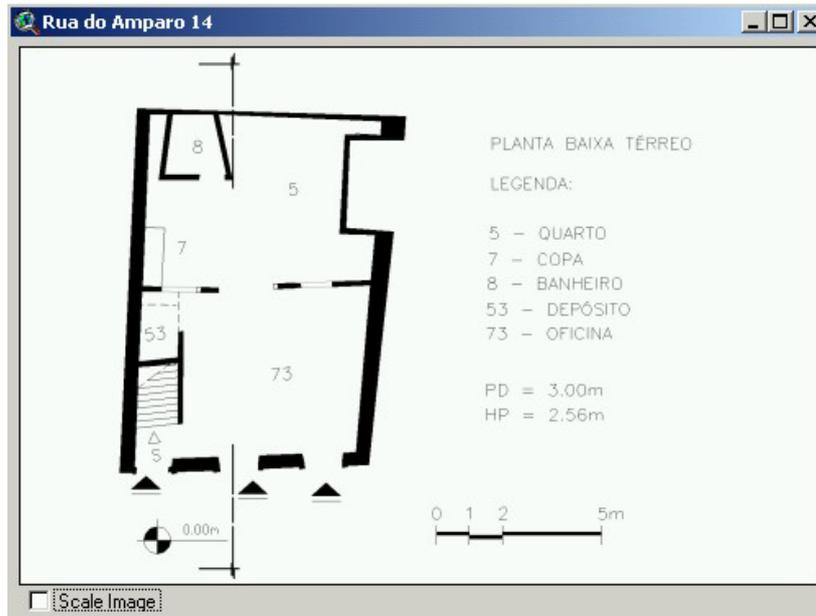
Tela com a Planta Baixa do Térreo do Imóvel Selecionado
